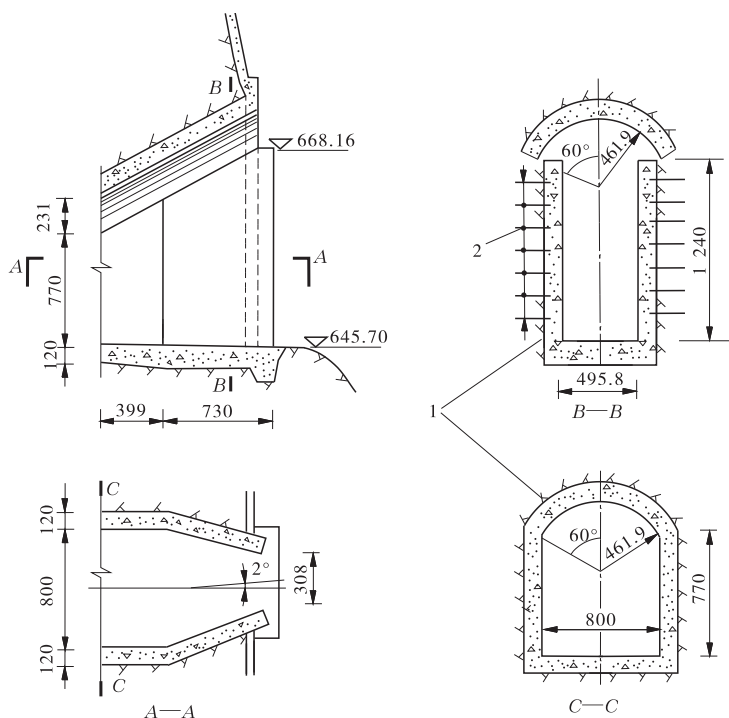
隧洞出口窄缝挑坎消能图 (高程单位:m;尺寸单位:cm)
